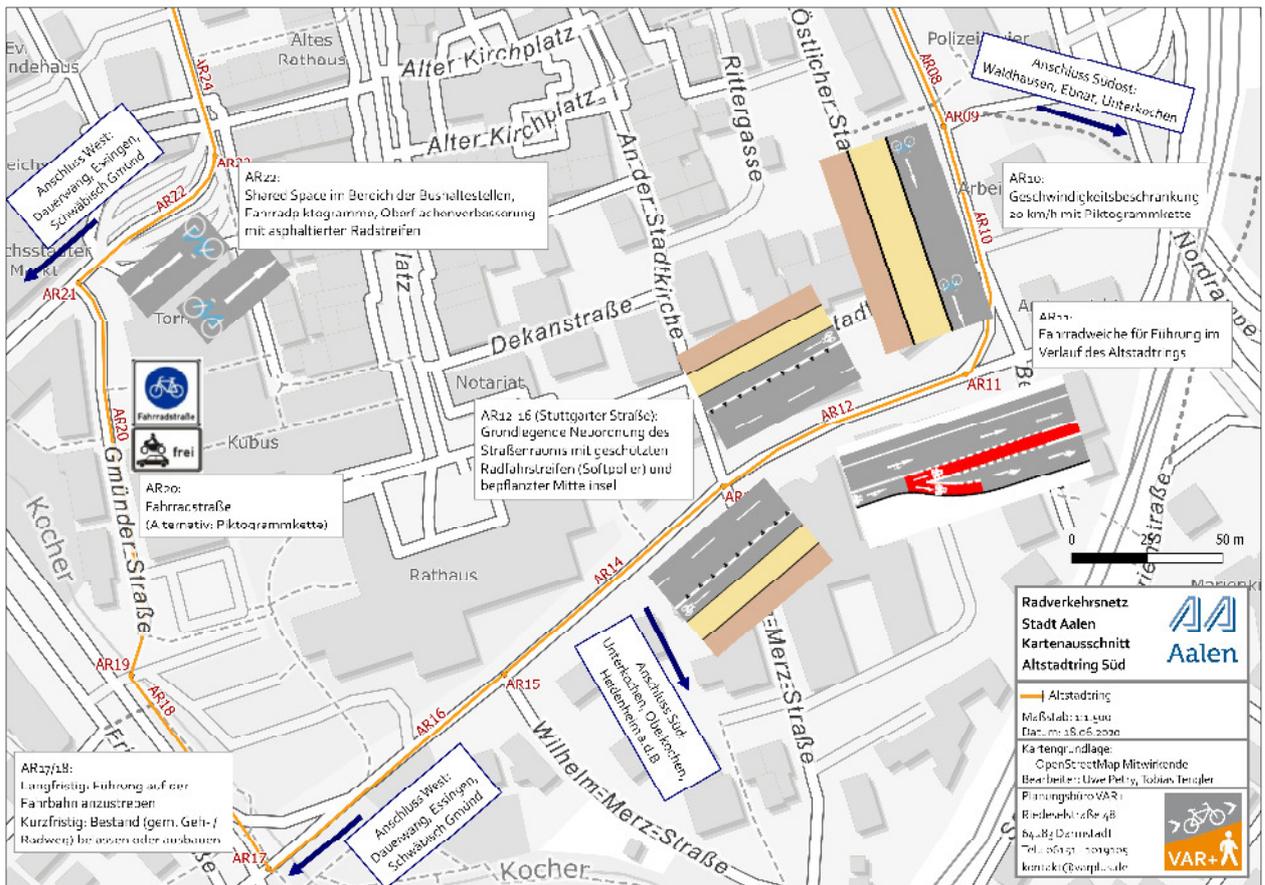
Markierung Altstadttring (südlicher Bereich; Bahnhofstr., Stuttgarter Str., Gmünder Str.)
